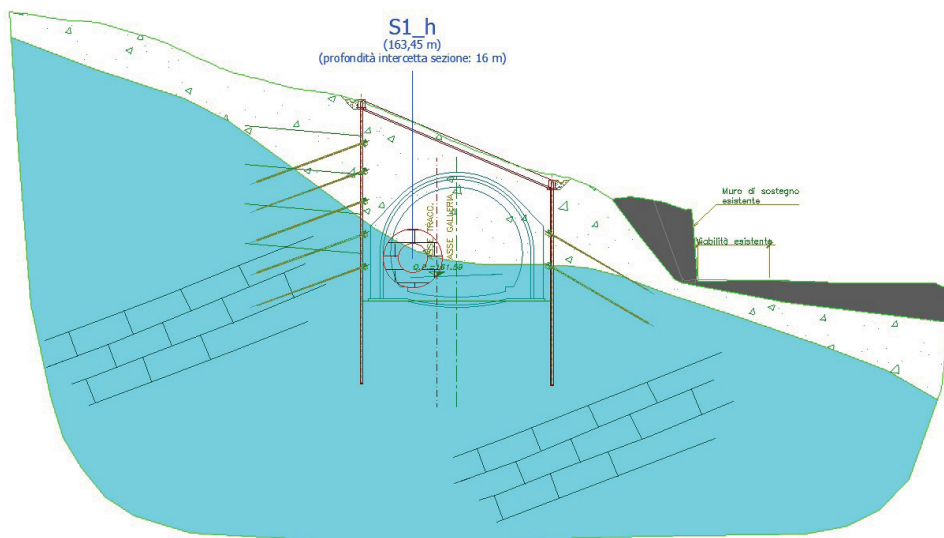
Sezione geologica trasversale Imbocco Sud
